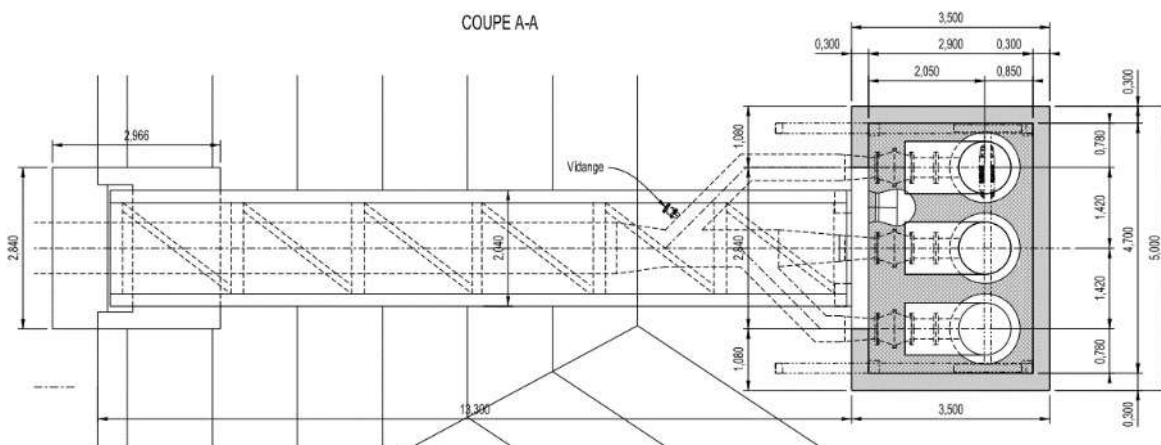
Vue en plan de l'implantation des pompes (source : ISL Ingénierie)
